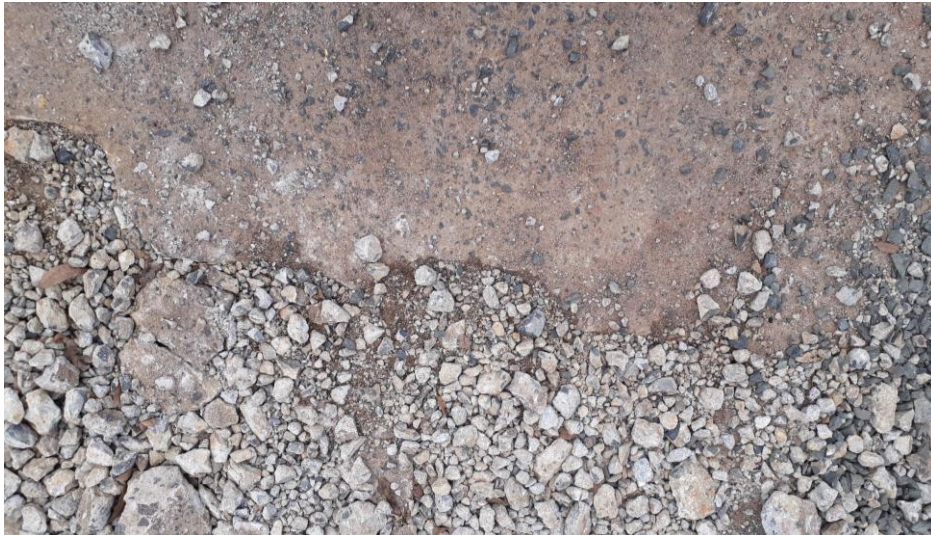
Fissuras horizontais e verticais no revestimento asfáltico
